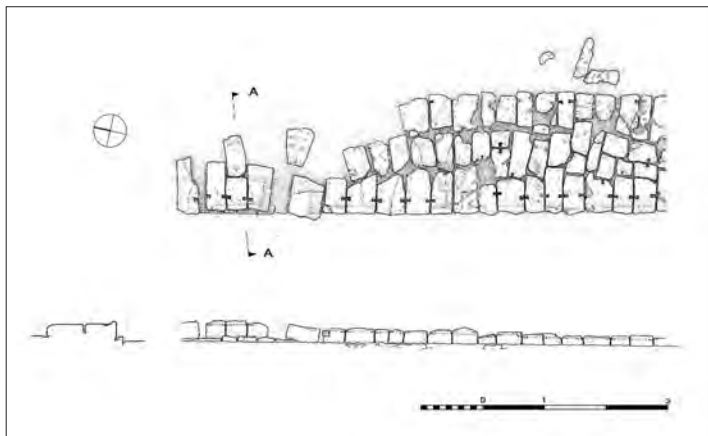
Westliche Mole, Detail. Plan, Schnitt und Ansicht (V. Stappmanns)
